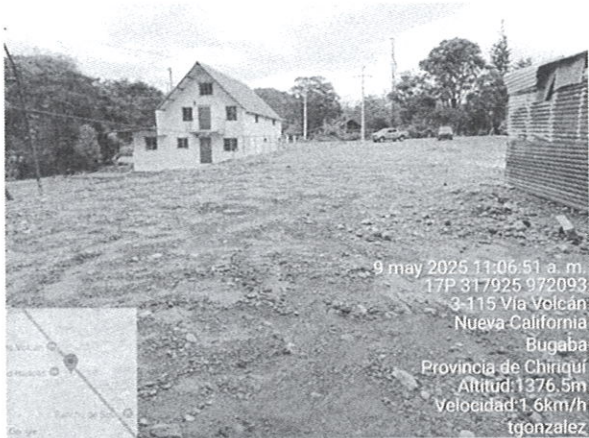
Vista de viviendas colindantes con el área del proyecto. Fuente: T. González. 2025
